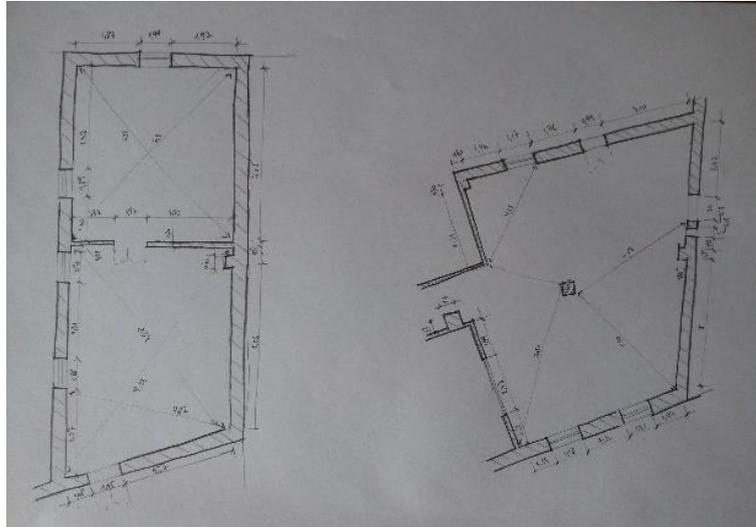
Croquizado de estancias planta primera. Fuente Propia.
